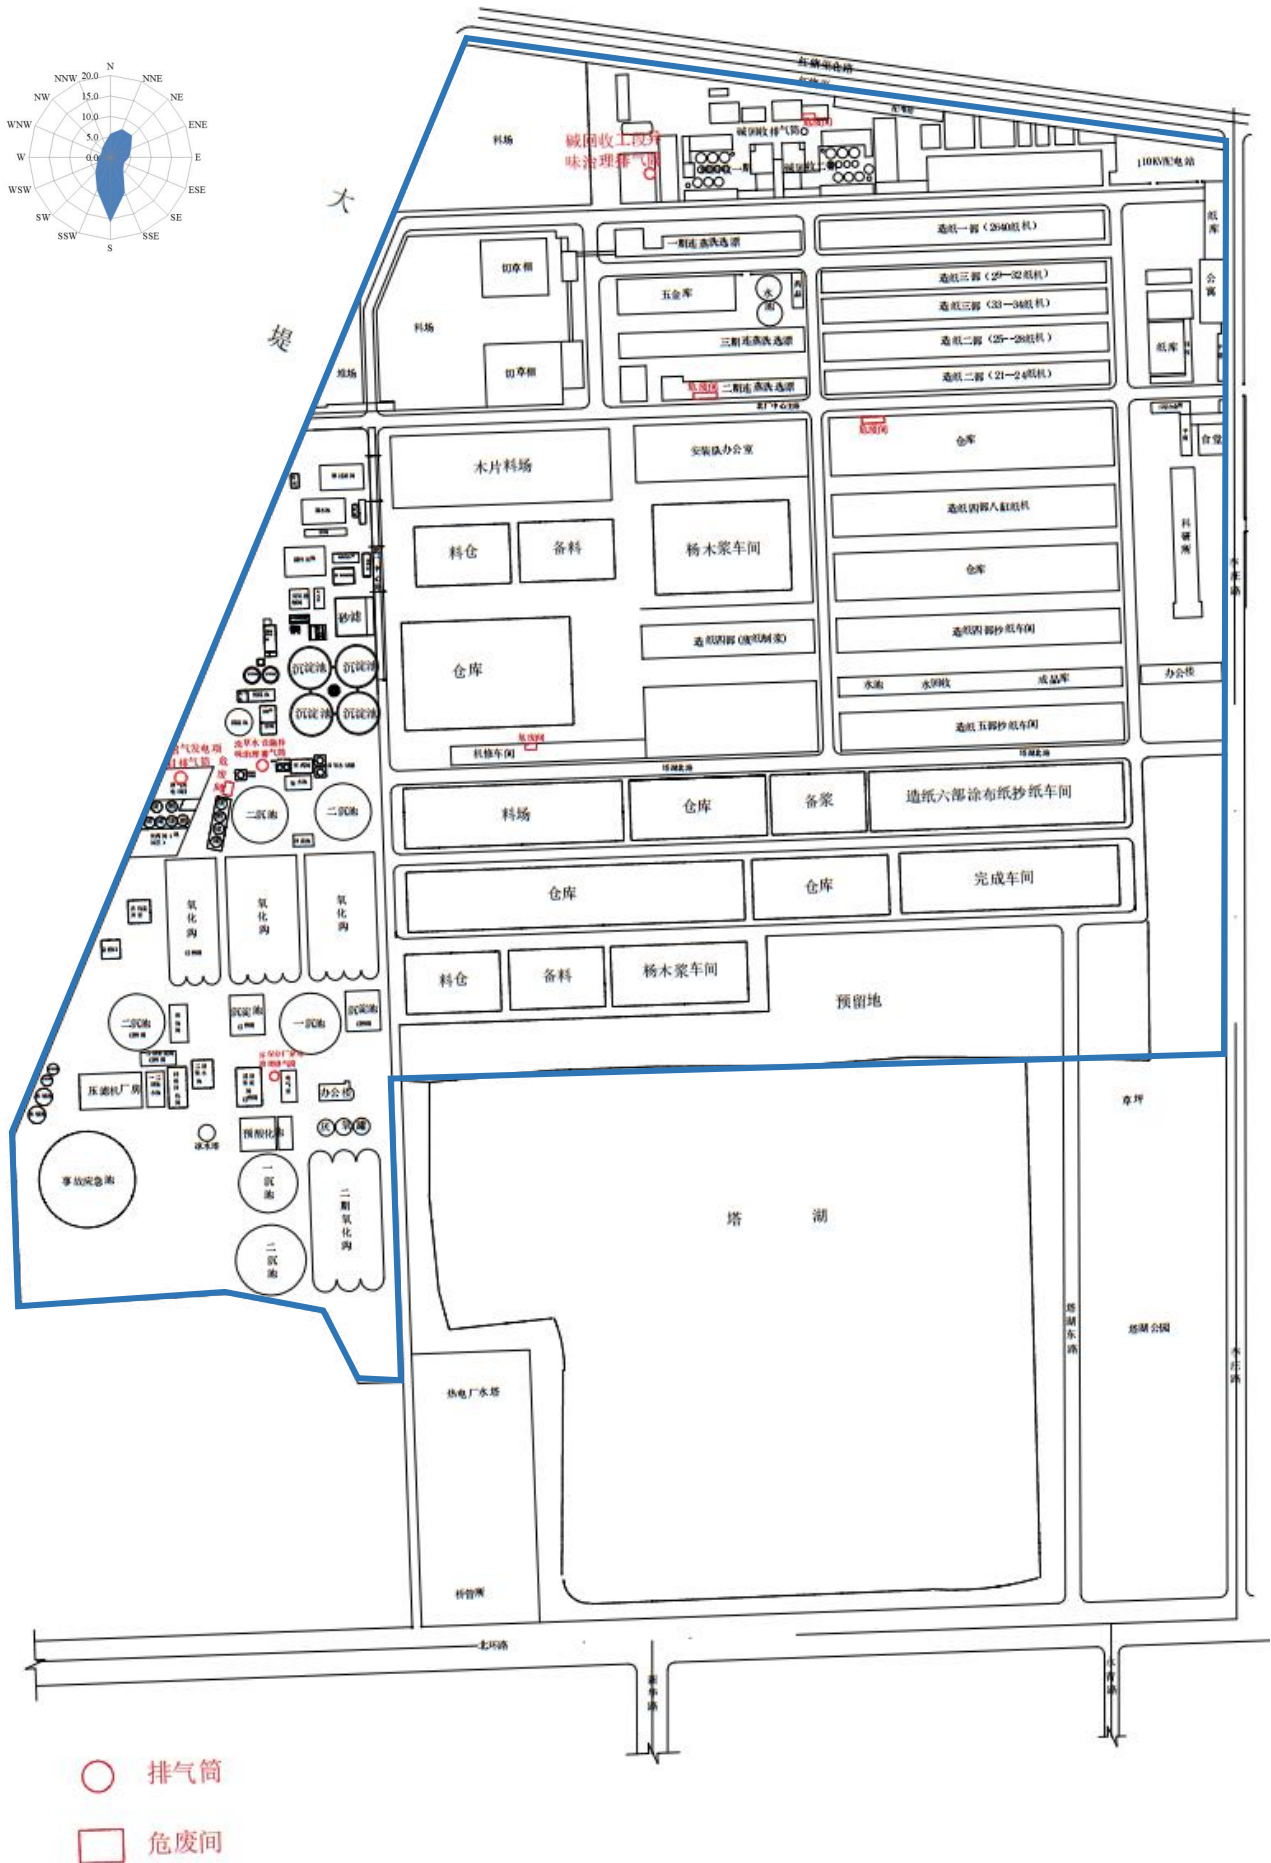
银河纸业北厂区总平面布置图 (比例尺 1:2000)
